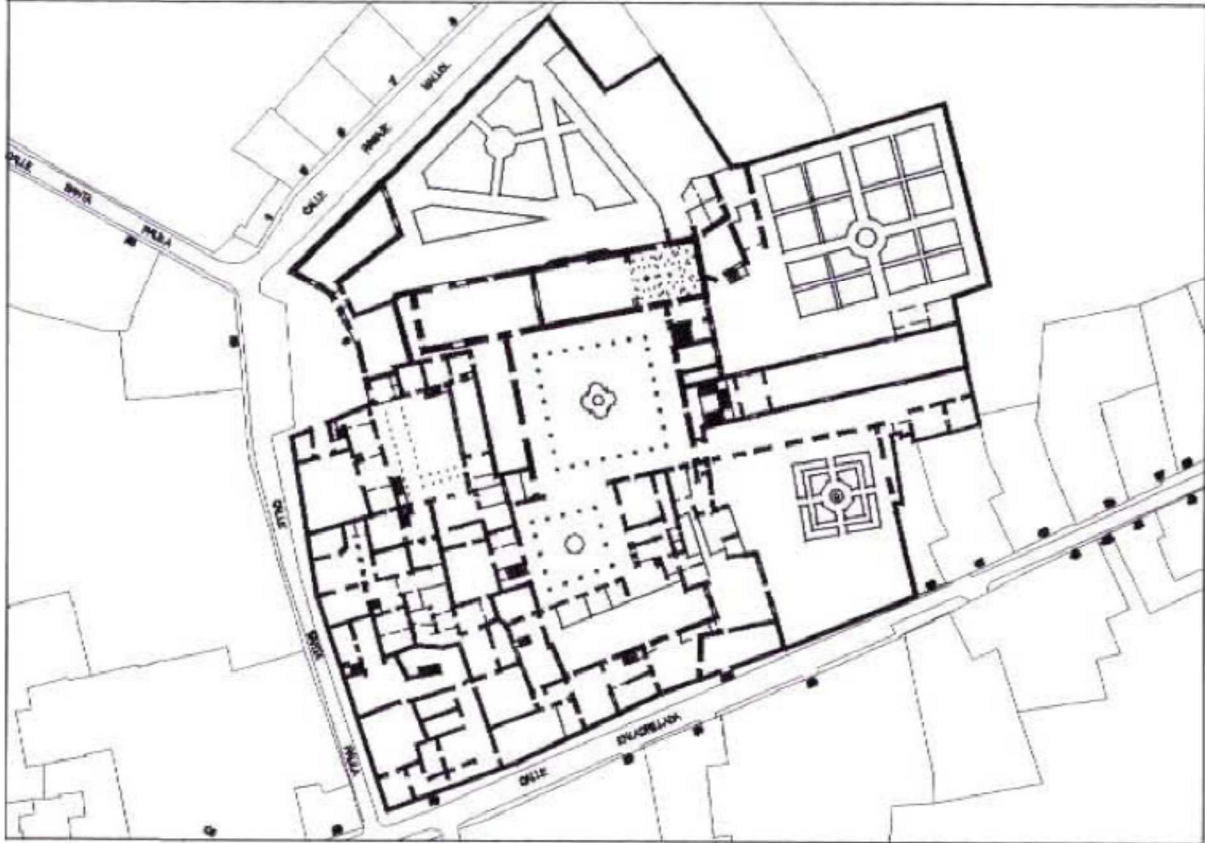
Planta general del monasterio. Plan Especial de Protección. Sector 3. Santa Paula-Santa Lucía.
